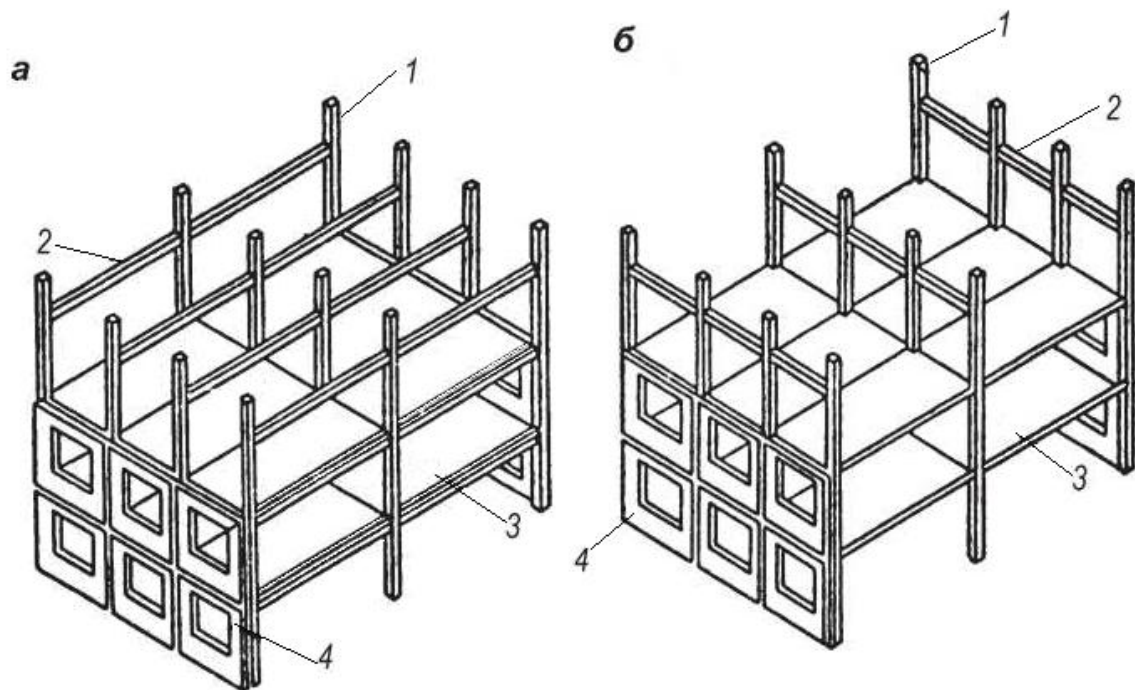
Конструктивні схеми каркасно-панельних будівель: а – з поперечним розташуванням ригелів; б – з поздовжнім розташуванням ригелів; 1 – колони; 2 – ригелі; 3 – плити перекриття; 4 – стінові панелі
